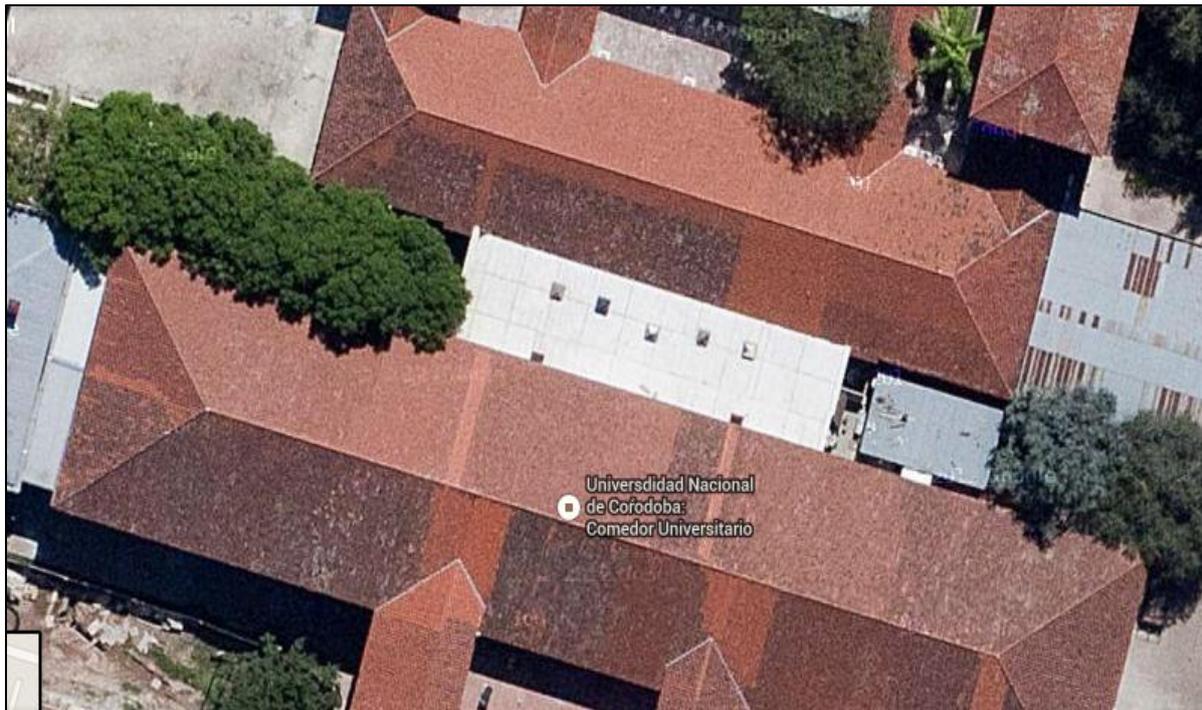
Cubierta inclinada del comedor y cubierta plana de los baños.
